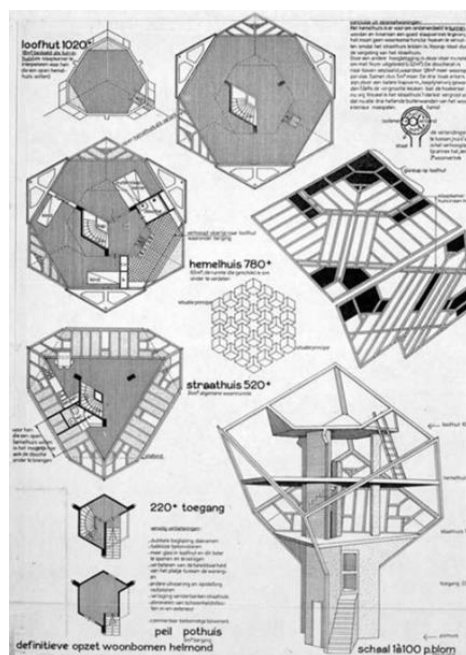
Planos de Casa Cubo. Fuente: <https://ar.pinterest.com/pin/78813062205542155/>
